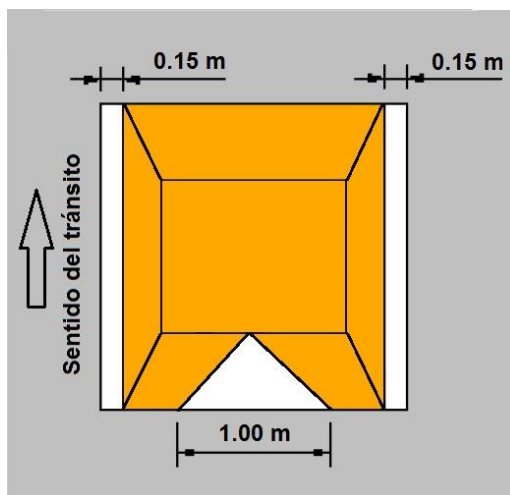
Ejemplo Resalto de Sección Trapezoidal
